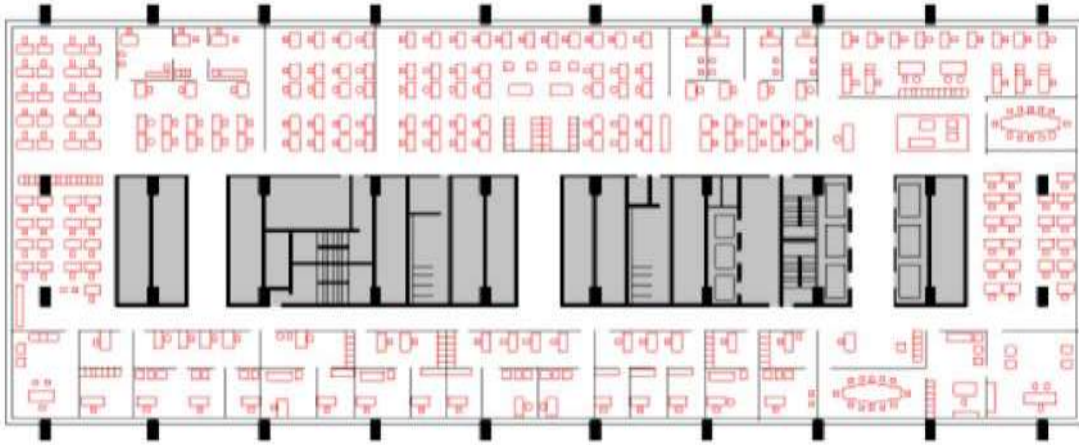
Johnson-Wax Binasının Planı (Url-5).
